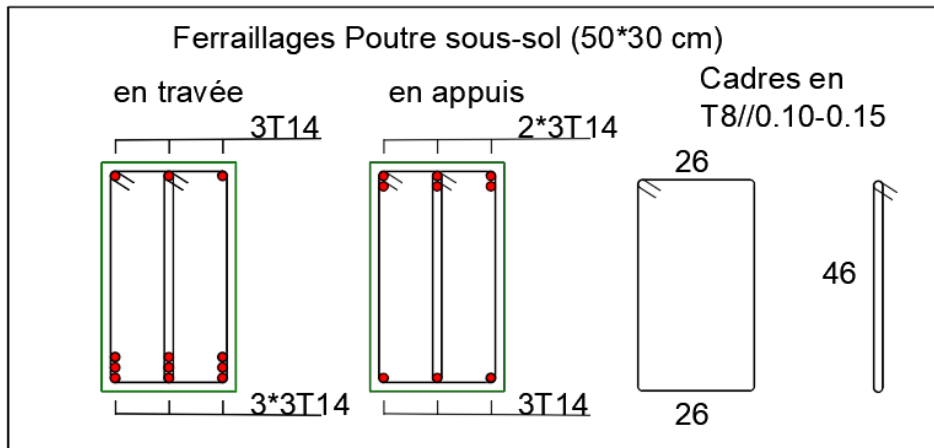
Ferrailages Poutre Sous-sol 50*30 cm.
